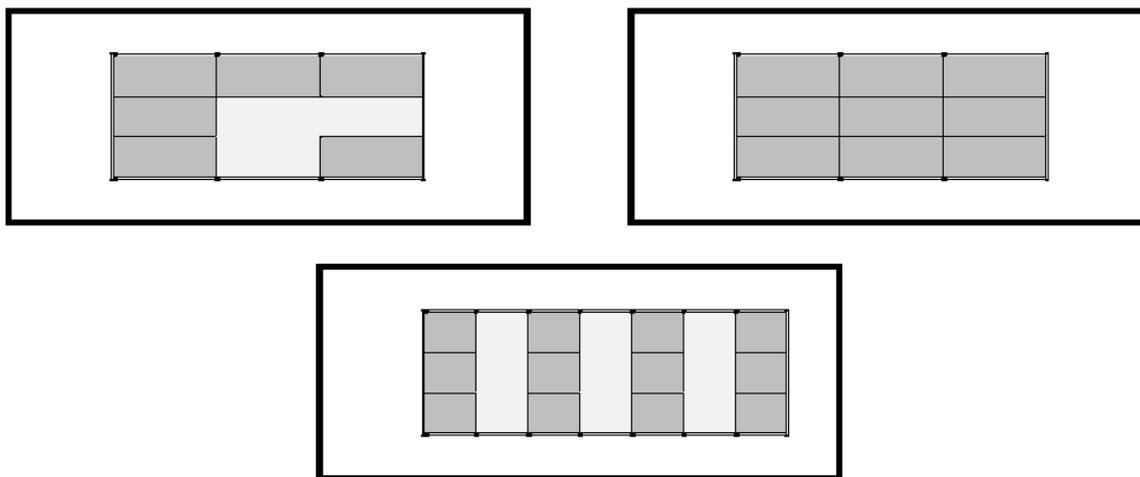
Принципиальные схемы остекления фасадов зданий
